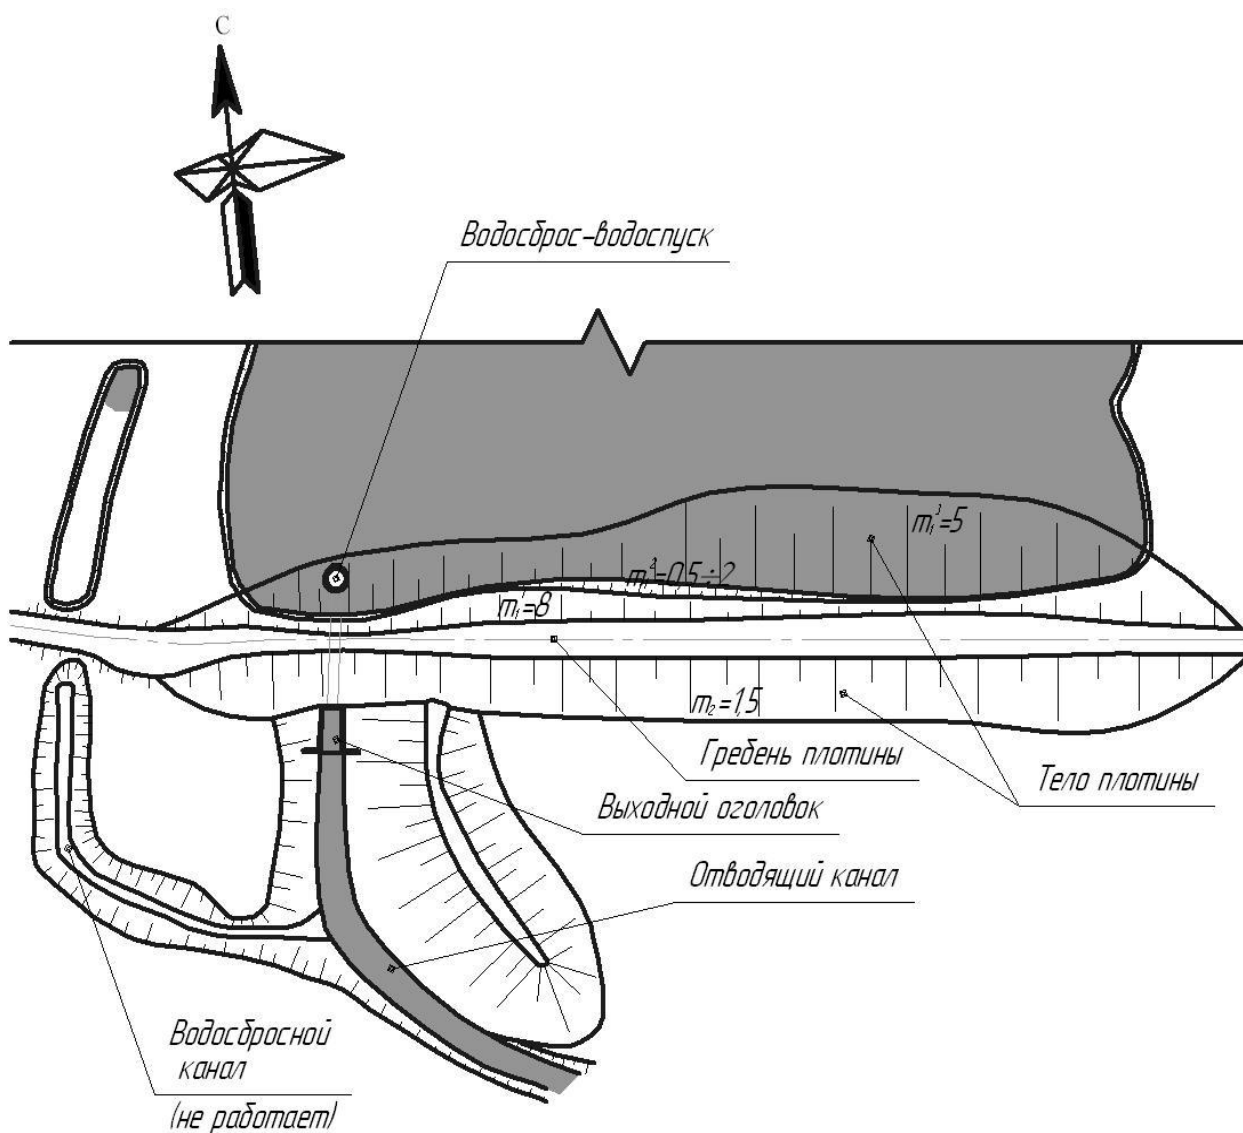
Схема гидроузла на балке Волчье Логово
